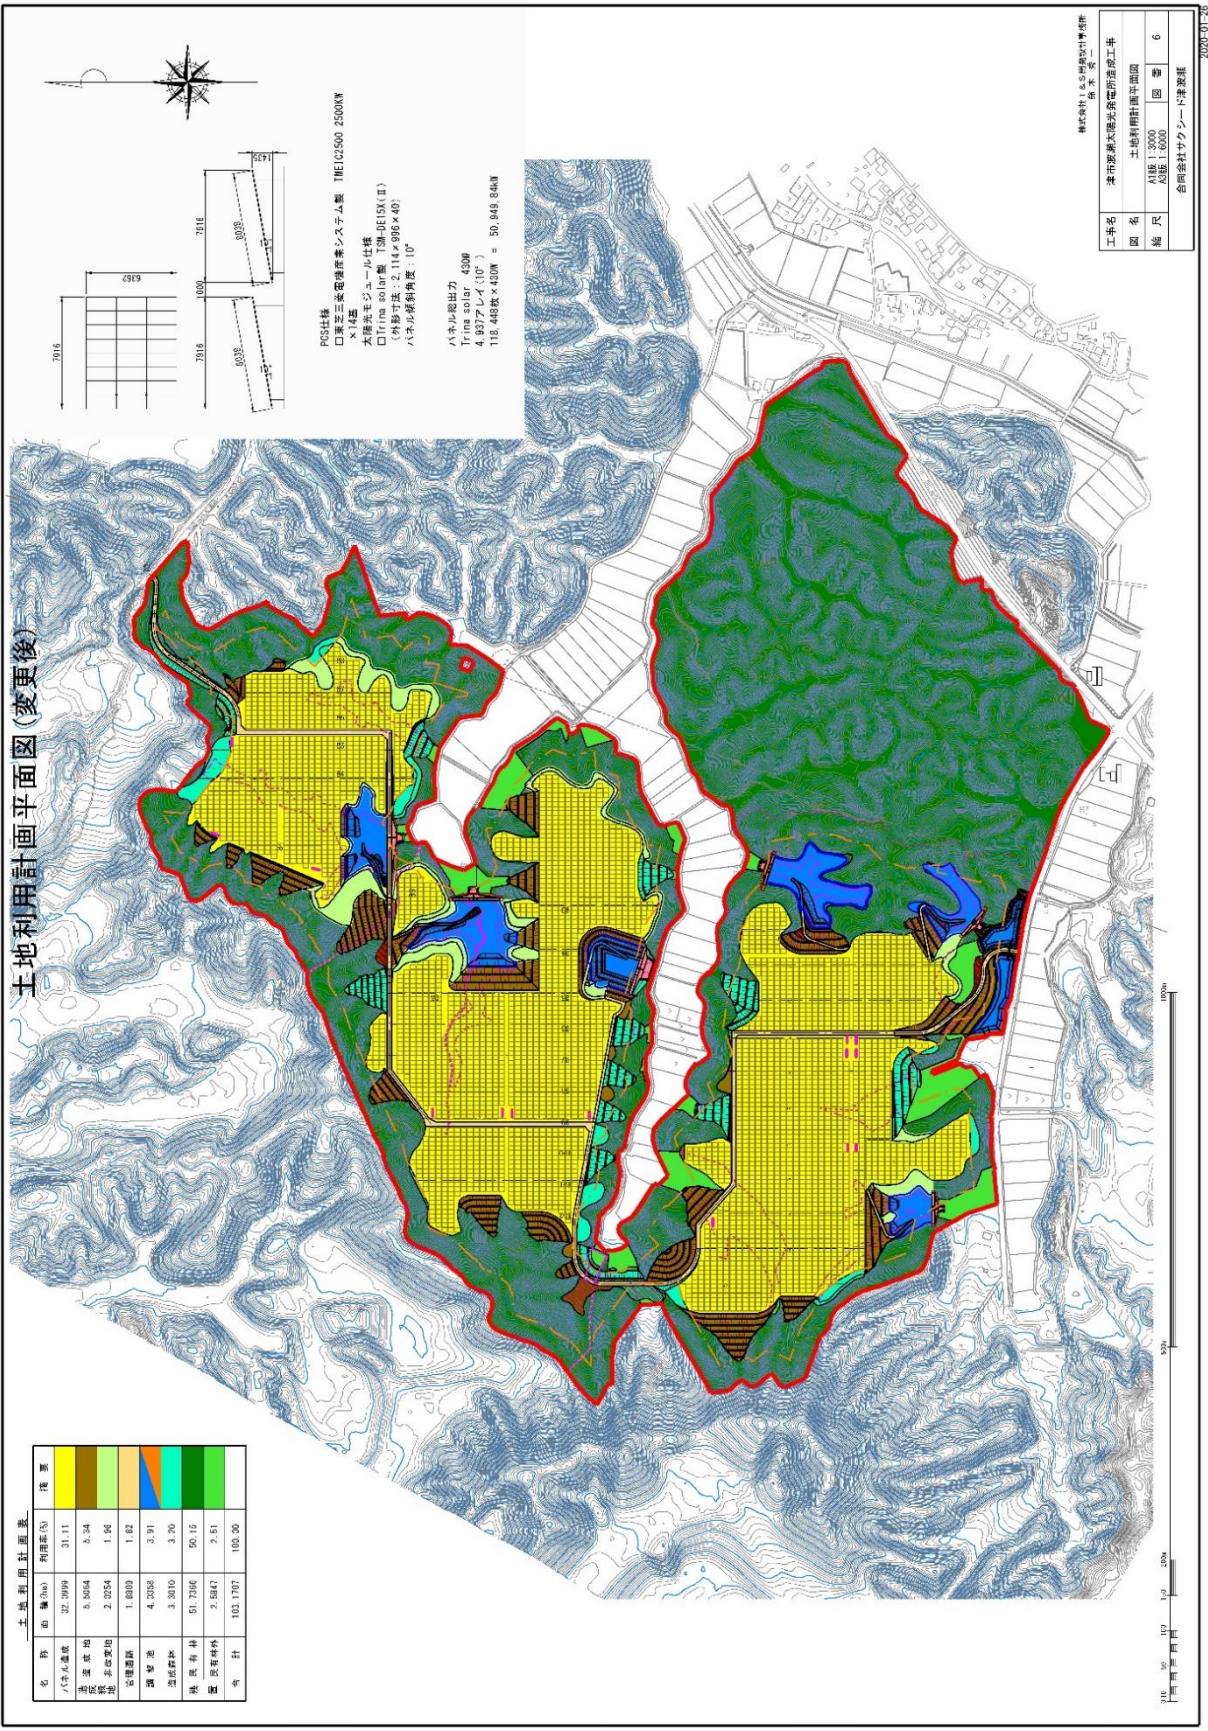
土地利用計画平面図 (現計画 : 第 2 回変更時)
